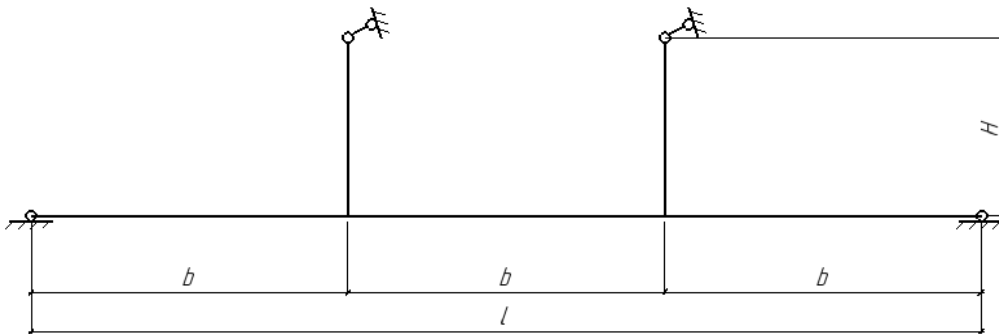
Расчётная схема нижнего пояса для расчета на горизонтальный изгиб и кручение (H – высота ППФ по осям пояса)
